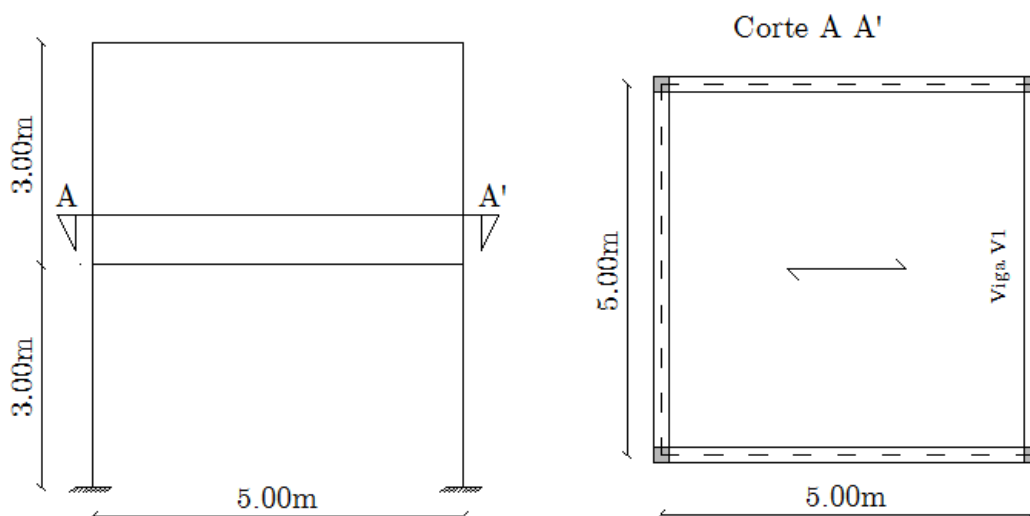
Vista em alçado e em planta da estrutura porticada do edifício
